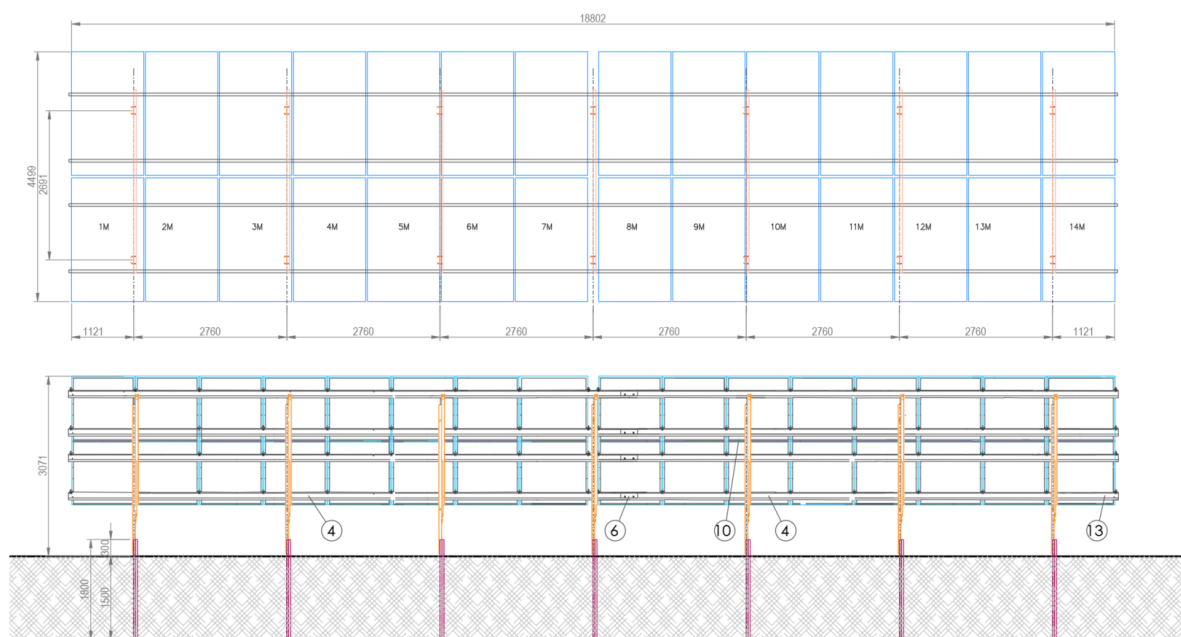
Pianta e prospetto struttura di supporto 2x14 moduli
